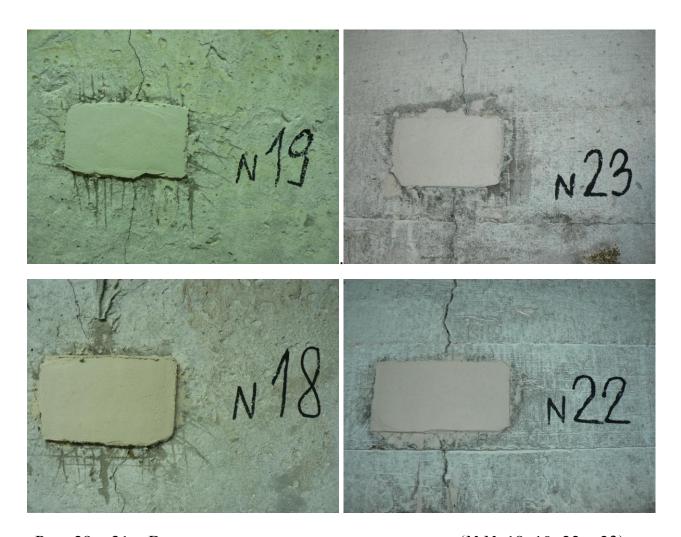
31 – Вновь установленные гипсовые маяки (№№ 18, 19, 22 и 23) на стенах подвала здания жилого дома, взамен поврежденных
